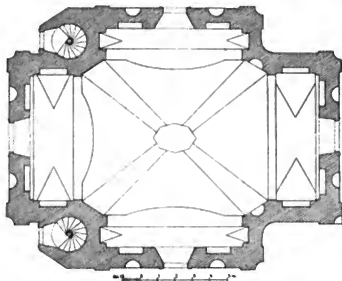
Vřířek. Grundriss der Kapelle.
